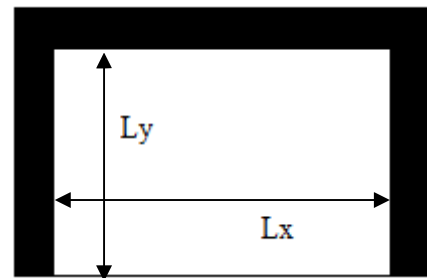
Schéma de ferrailages de la dalle sur deux appuis.
